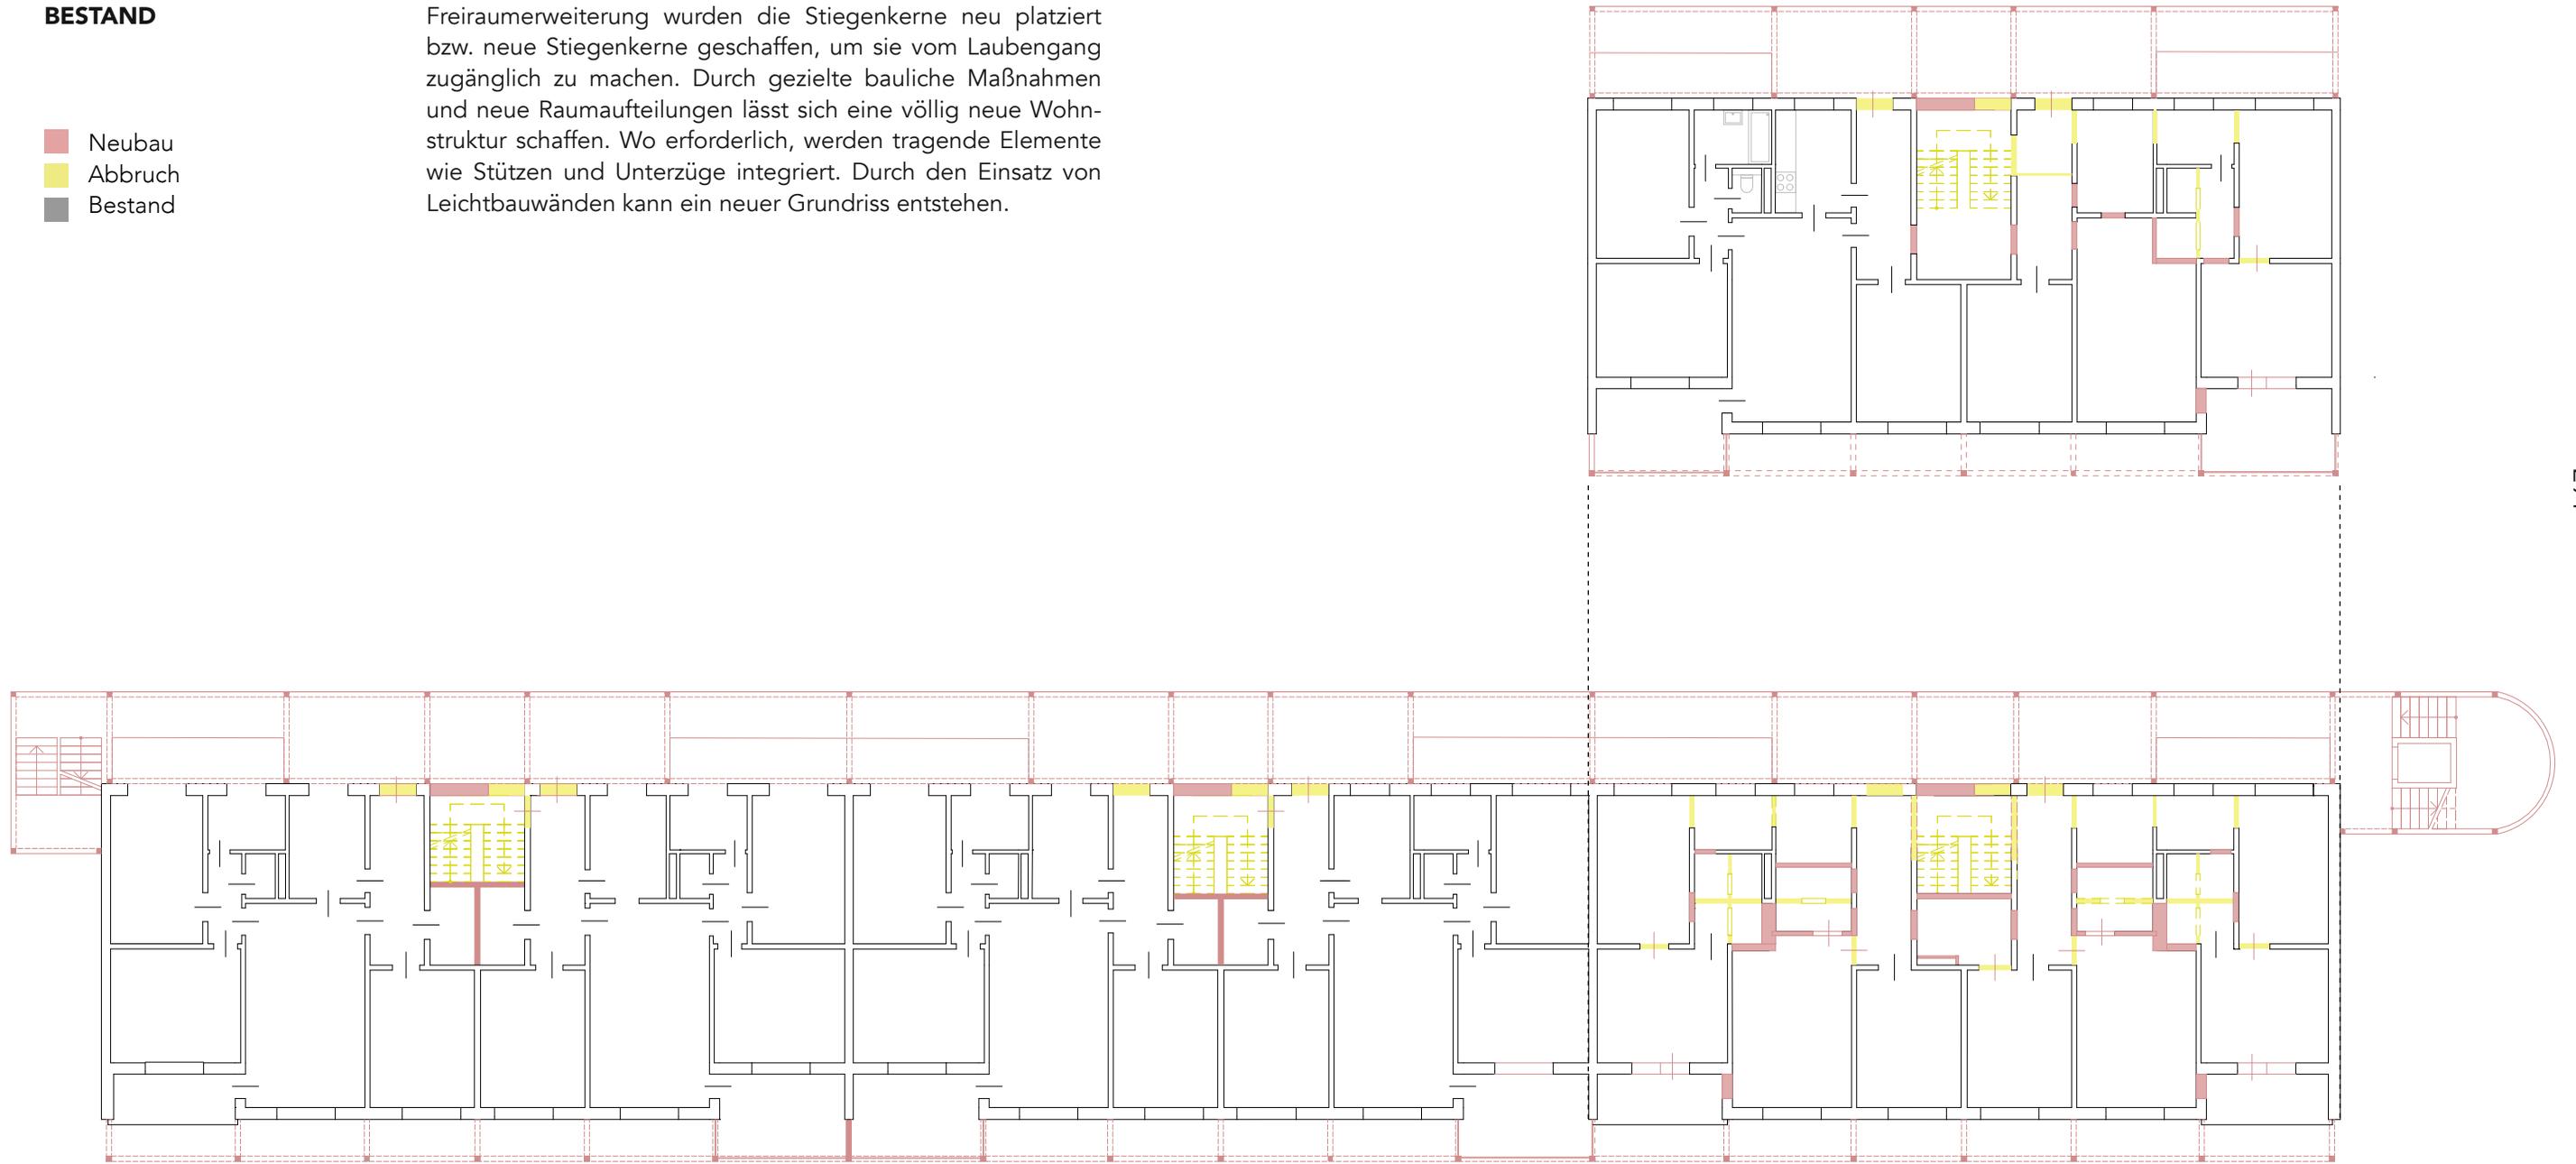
Grundriss Eingriff im Bestand M 1:200
